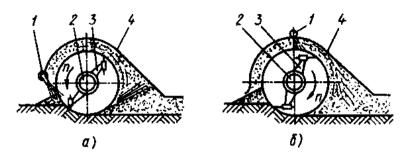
Схемы резания грунта: а – в направлении сверху вниз; б – в направлении снизу вверх; 1 – дозатор вяжущего; 2 – вал ротора; 3 – лопасть; 4 – кожух
